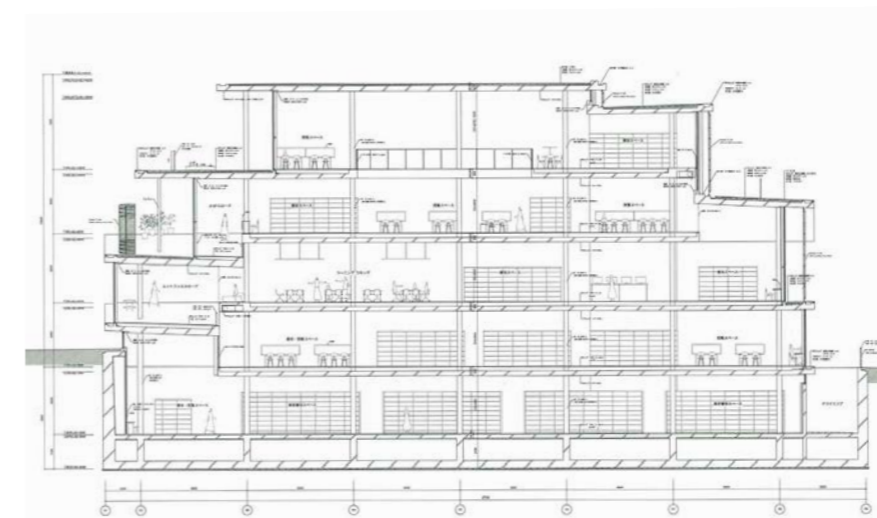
Corte transversal construtivo. "Sección transversal constructiva".
